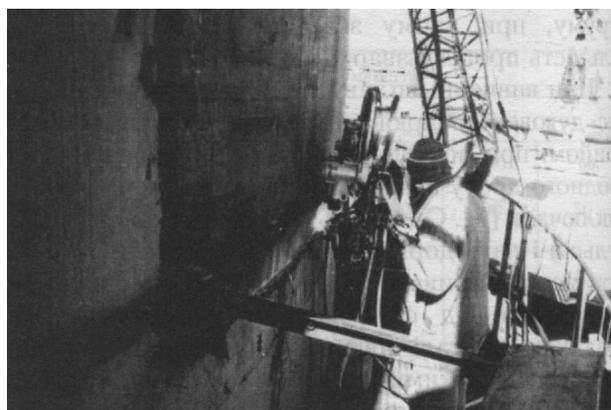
Автоматизированная сварка горизонтального шва стенки резервуара аппаратом АД-330М
